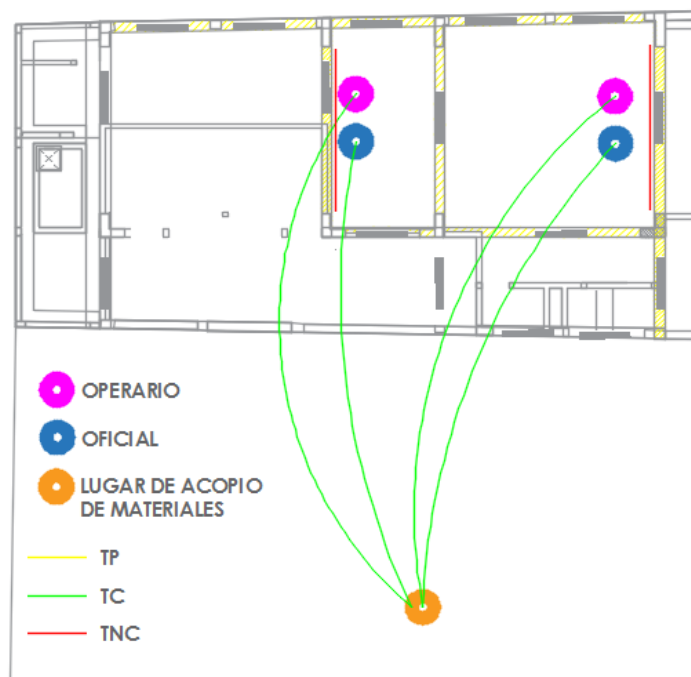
Diagrama Spaghuetti de la partida de Encofrado de Vigas de Cimentación
